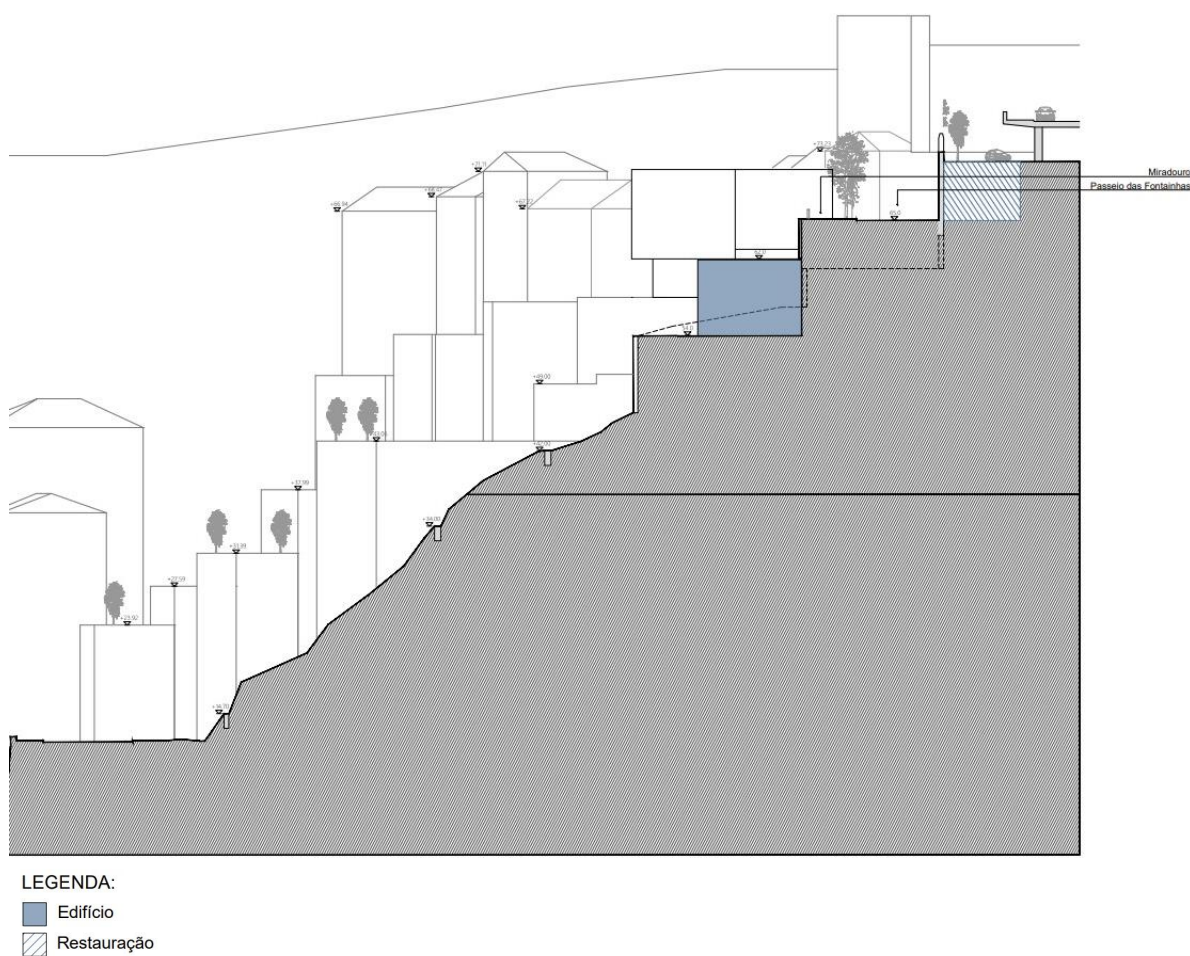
Corte transversal do Projeto V (Fonte: Autor)
